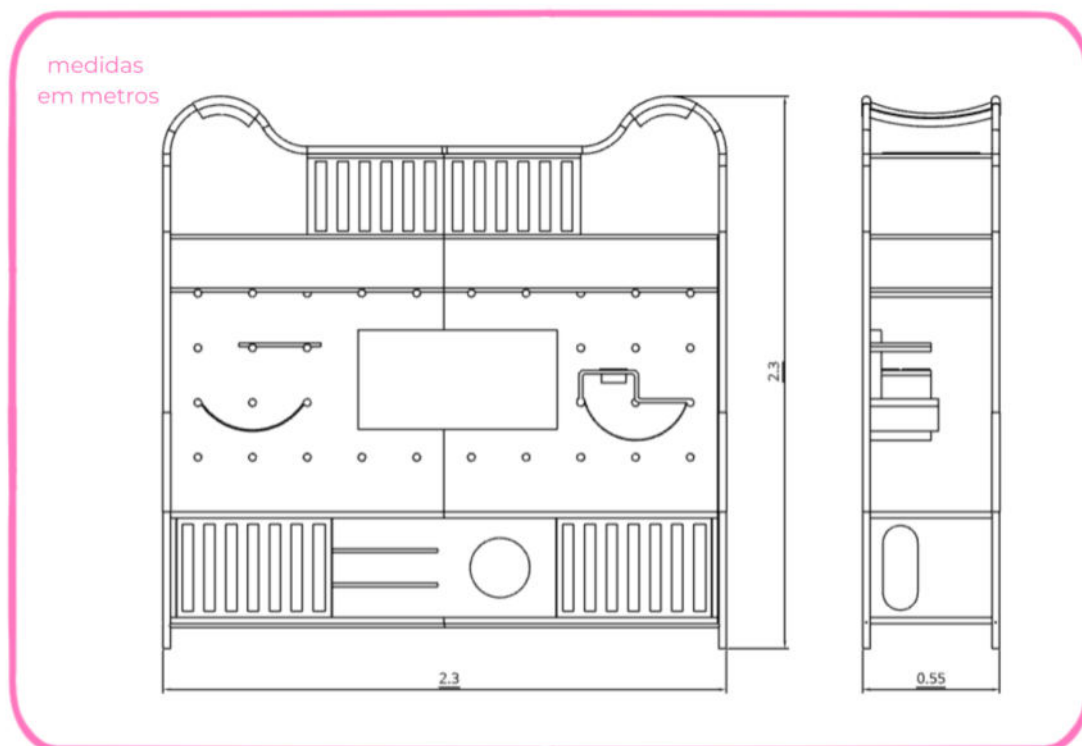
Layout sala de estar – apartamento 80 m<sup>2</sup>
